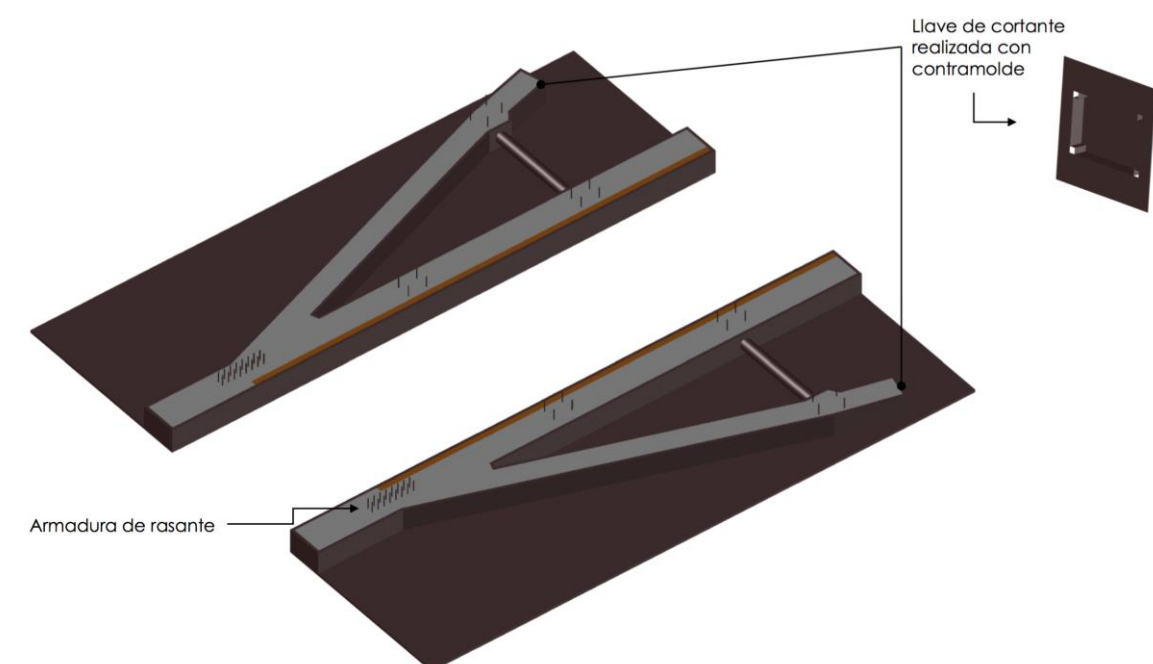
Elementos longitudinales hormigonados y detalles constructivos
